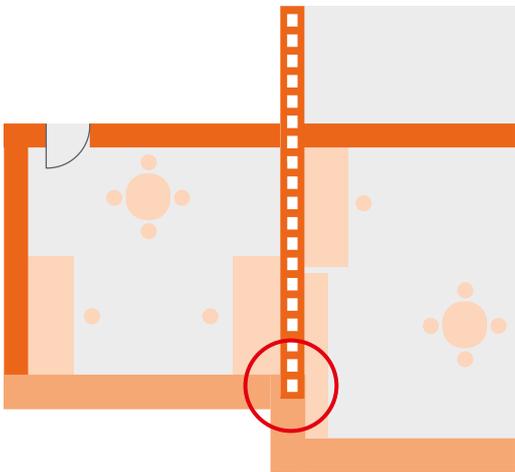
Beispiel einer Grundrissanordnung bei horizontalem Raumversatz
